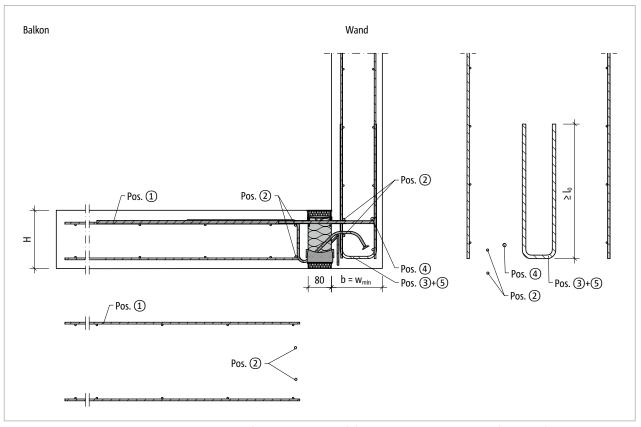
Schöck Isokorb® T Typ KL-U: Bauseitige Bewehrung für Anschluss am Wandfuß mit minimaler Bauteilabmessung ($w_{vorh} = w_{min}$)
